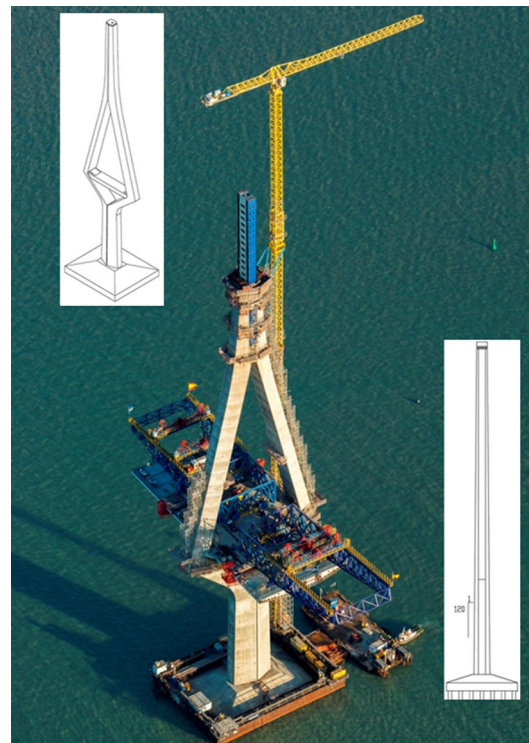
Torre en construcción con carros de izado de tablero perspectiva y alzado.
